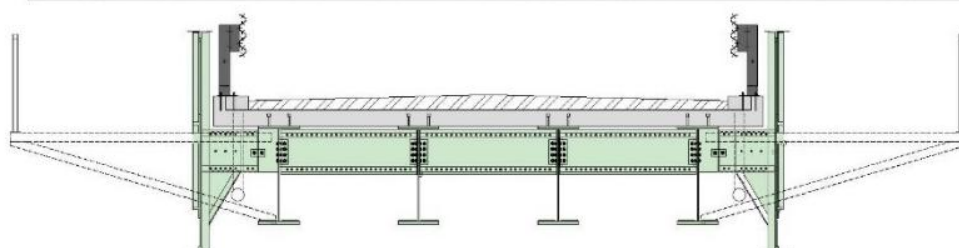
Sezione dell'impalcato allo Stato di Fatto ed allo Stato di Progetto
